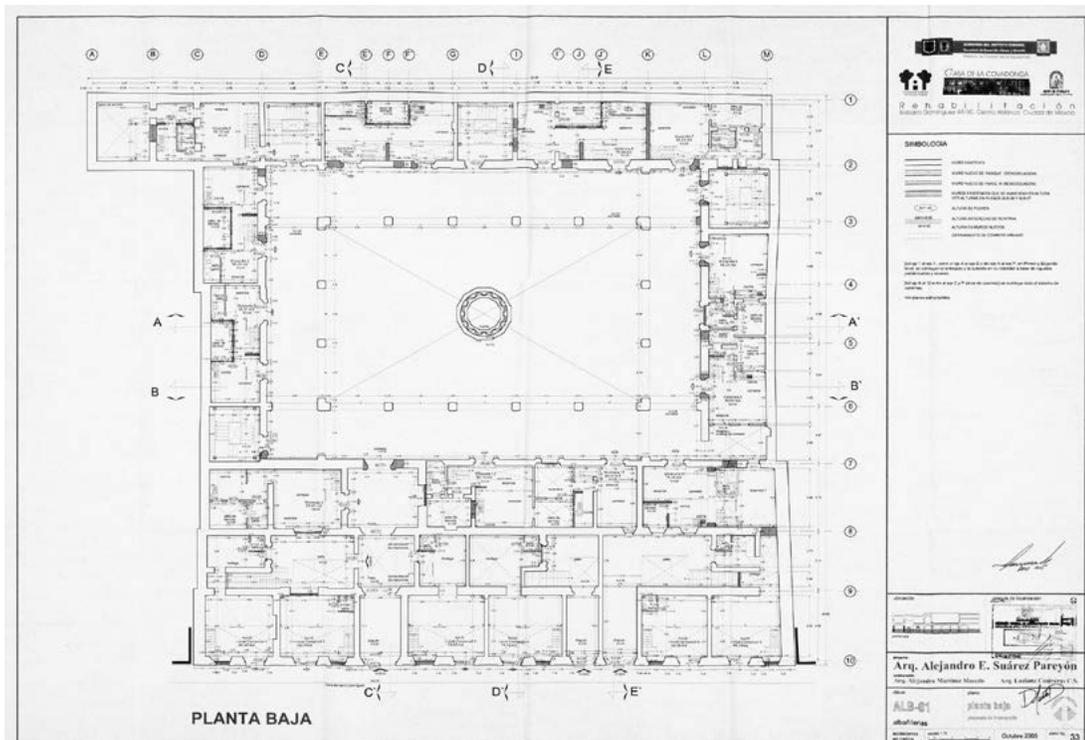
Planta baja. Propuesta de intervención. Diciembre de 2003. Arquitecto Alejandro Suárez Pareyón. AHJE-CNMHINAH.
